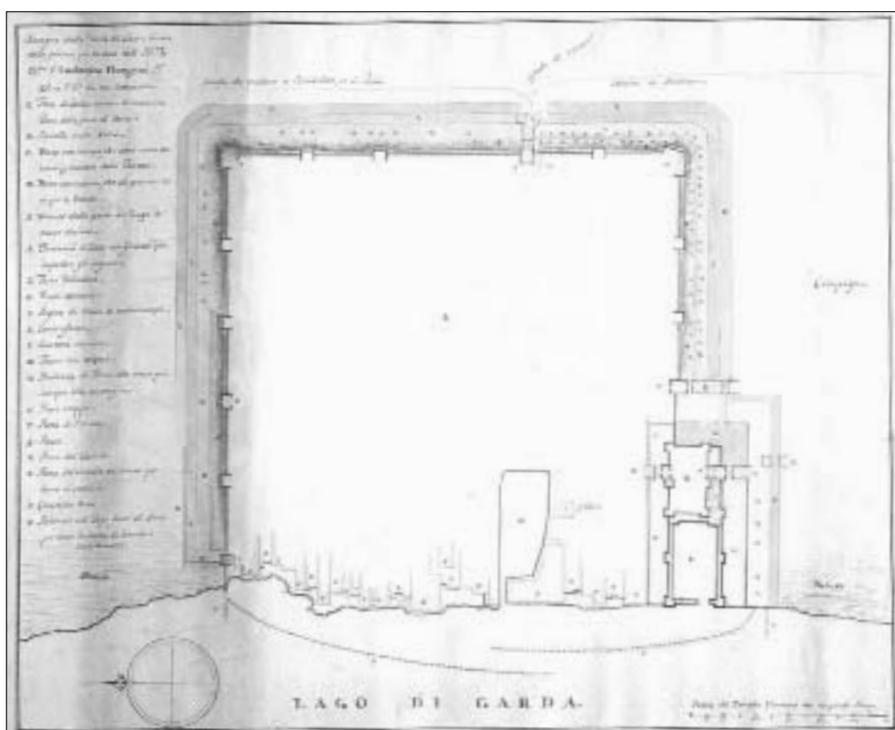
Metà XIX sec ca. Pianta e sezione del castello di Lazise. Kriegsarchiv, Wien.
